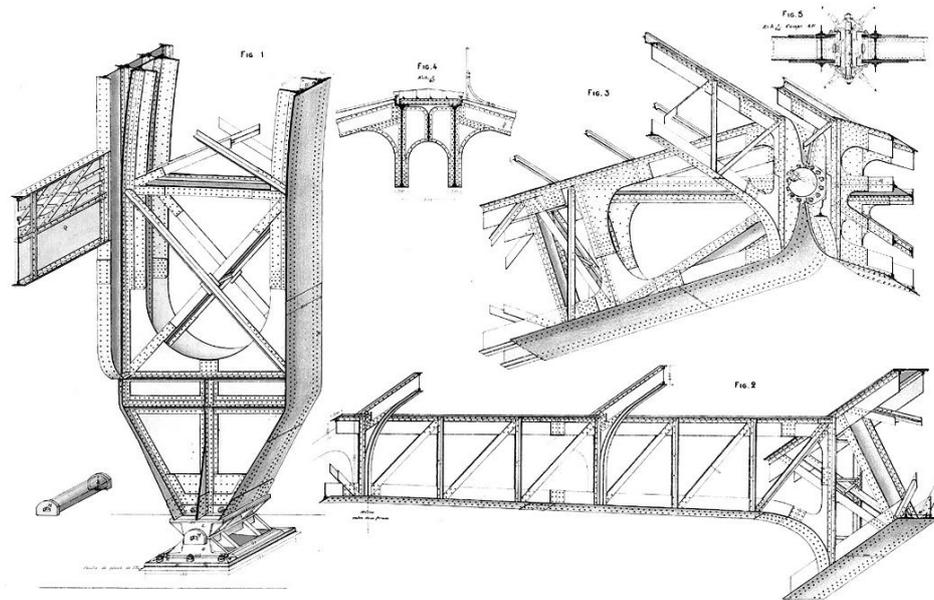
Despiece estructural de la nave central de la Galería de las Máquinas, con los cuatro niveles estructurales: arcos triarticulados, vigas de celosía de canto variable, vigas de sección H y barras de carpintería de cubierta. (Vierendeel, 1902)
